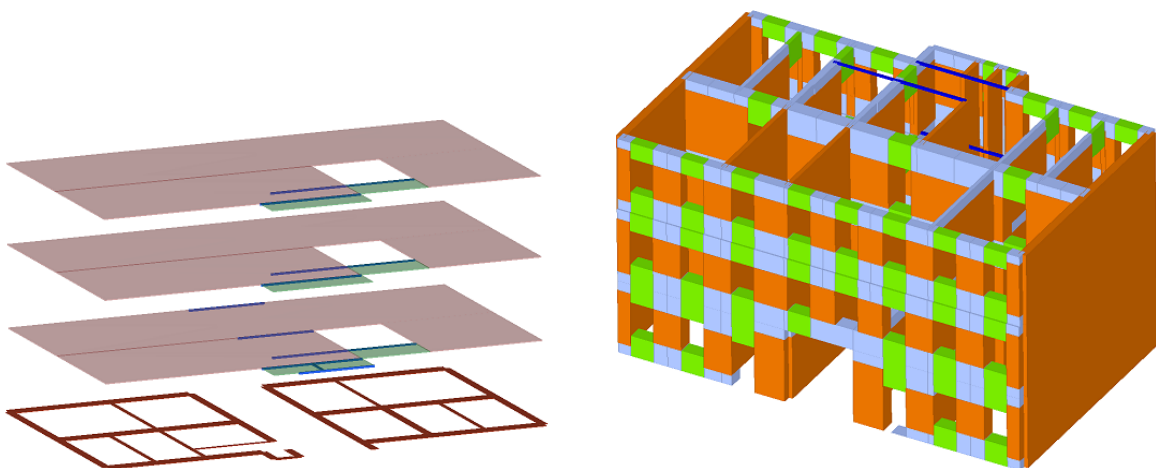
symmetrischer Grundriss, Links: Mauern im Erdgeschoss inklusive der darauf folgenden Deckenebenen; Rechts: Einteilung der Marko-Elemente
